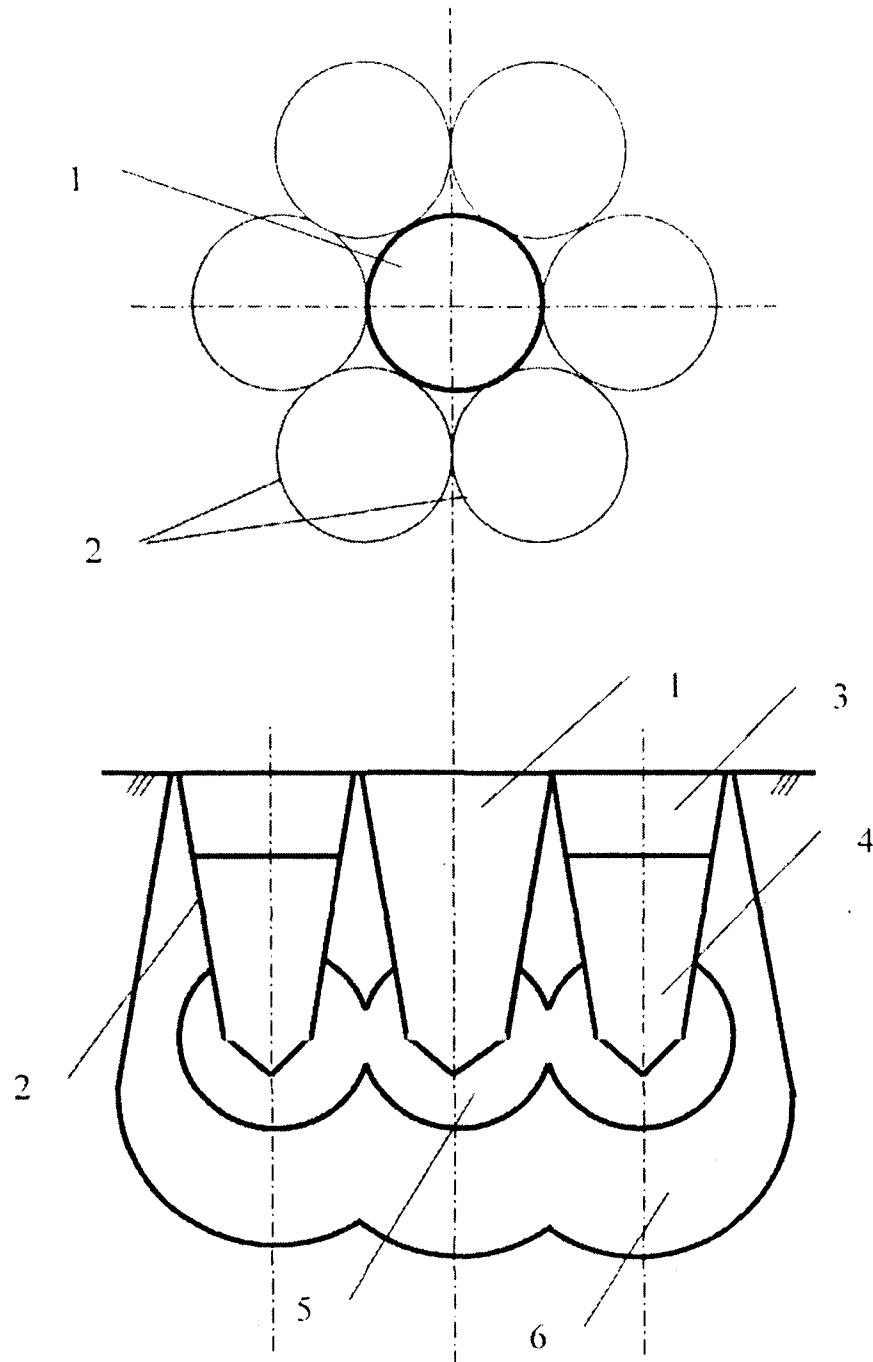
Схема фундамента в вытрамбованном котловане с несущим слоем.
